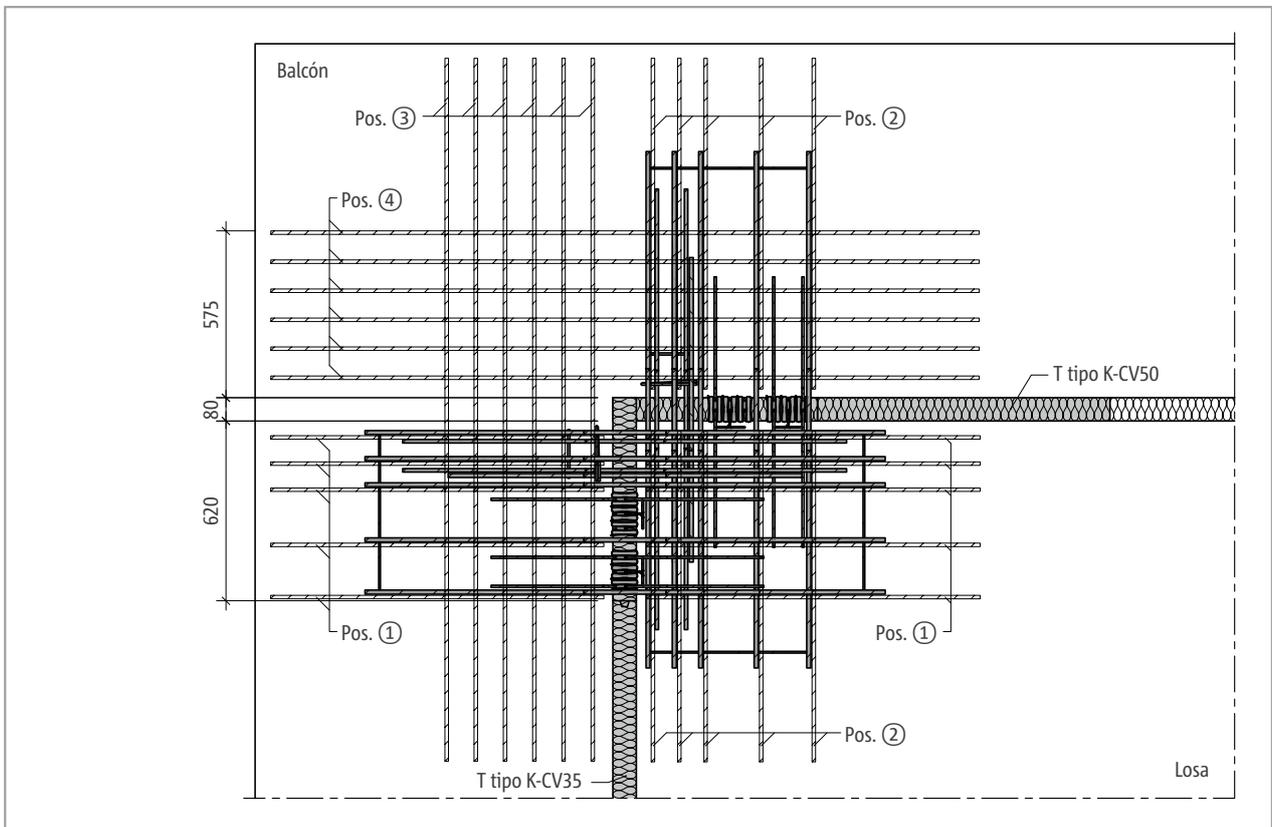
Schöck Isokorb® T tipo C-M2: Armadura in situ (posición superior)
